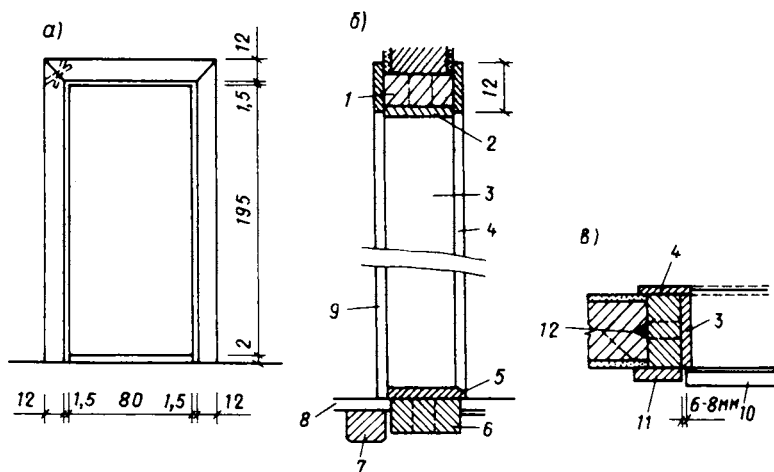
Вертикальный и горизонтальный разрезы черновой дверной коробки
